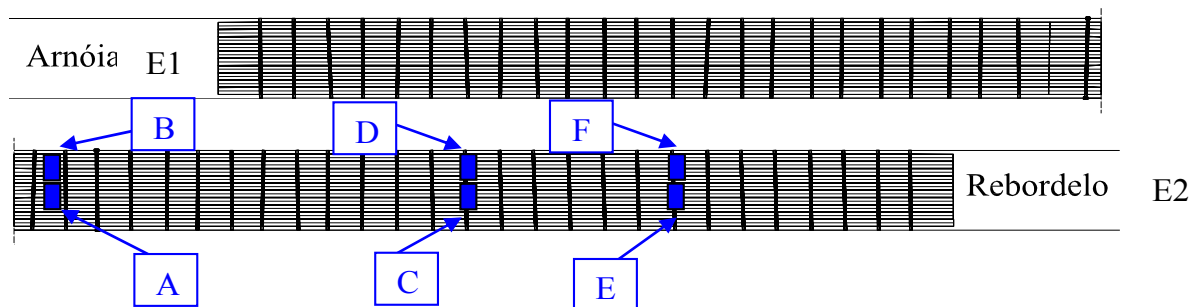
Localização dos pontos de medições (vista em planta).
